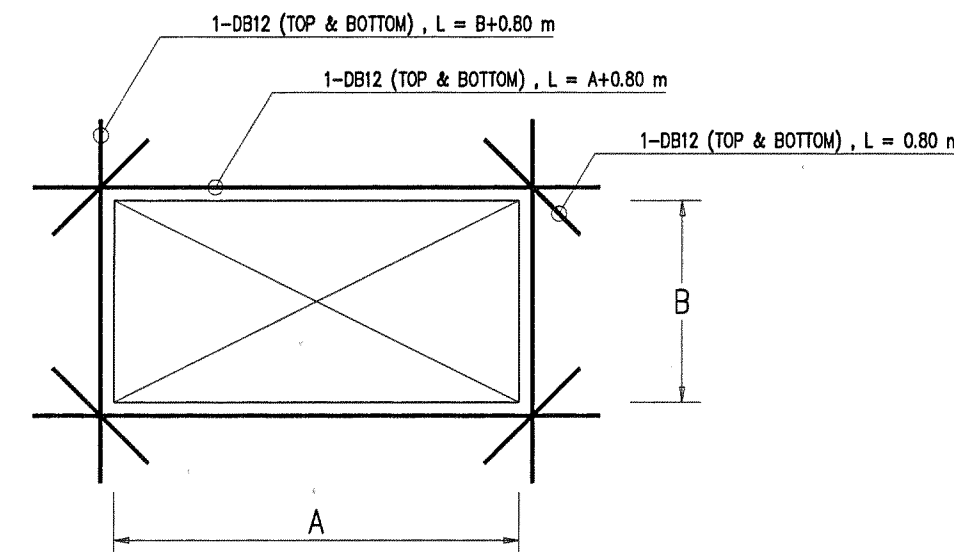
การทวนเหล็กค้ำแรงกลาง
